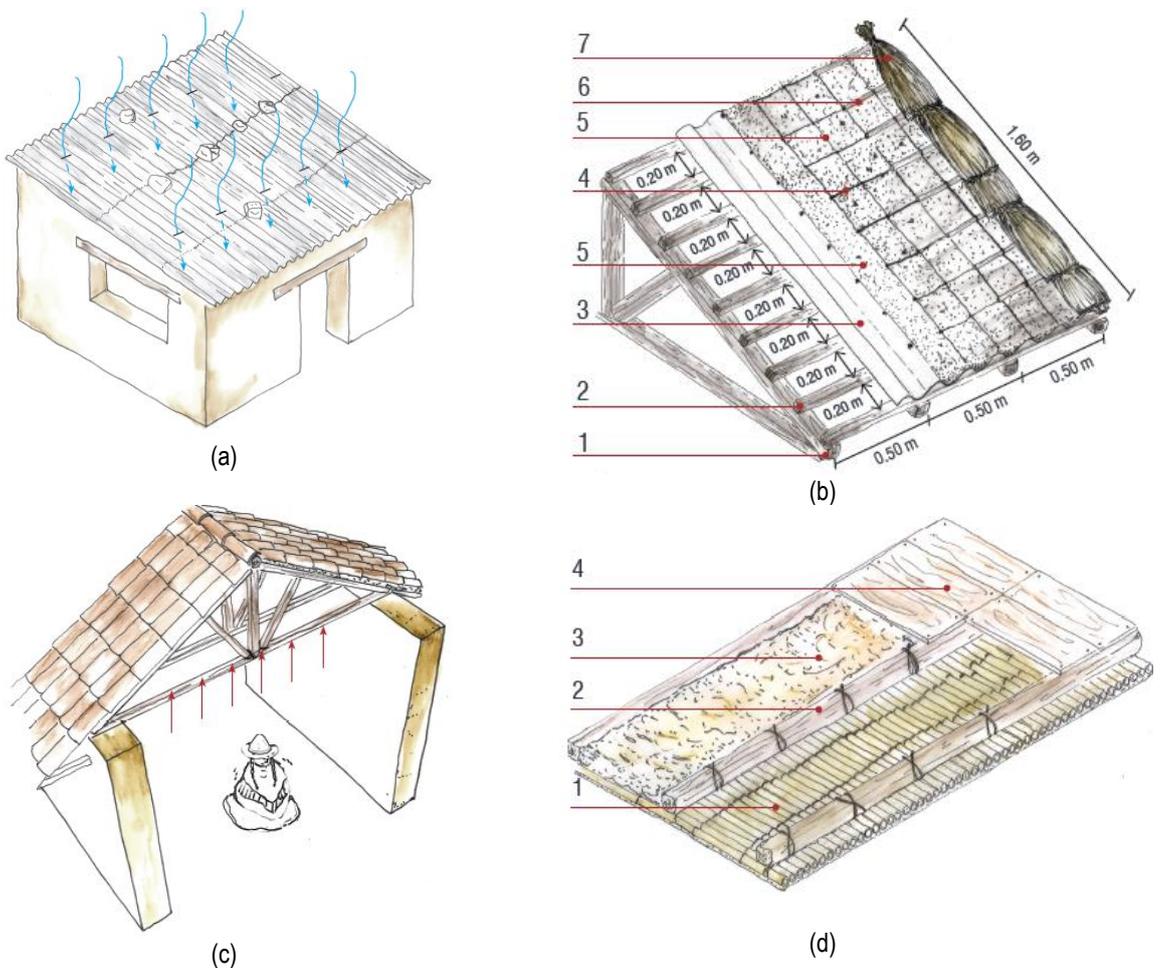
Aislamiento exterior: Problema (a) y solución constructiva (b) (1- 2= estructura existente; 3=chapa existente; 4= Cuerdas; 5= Paja-Barro; 6=Listones de madera; 7= cubierta de paja.). Aislamiento interior: Problema (c) y solución constructiva (d) (1= caña revestida al interior con yeso; 2=estructura existente; 4= relleno de paja-barro; 5= entablado de madera (si hay dos pisos) (Von Hesse et al., 2014).
